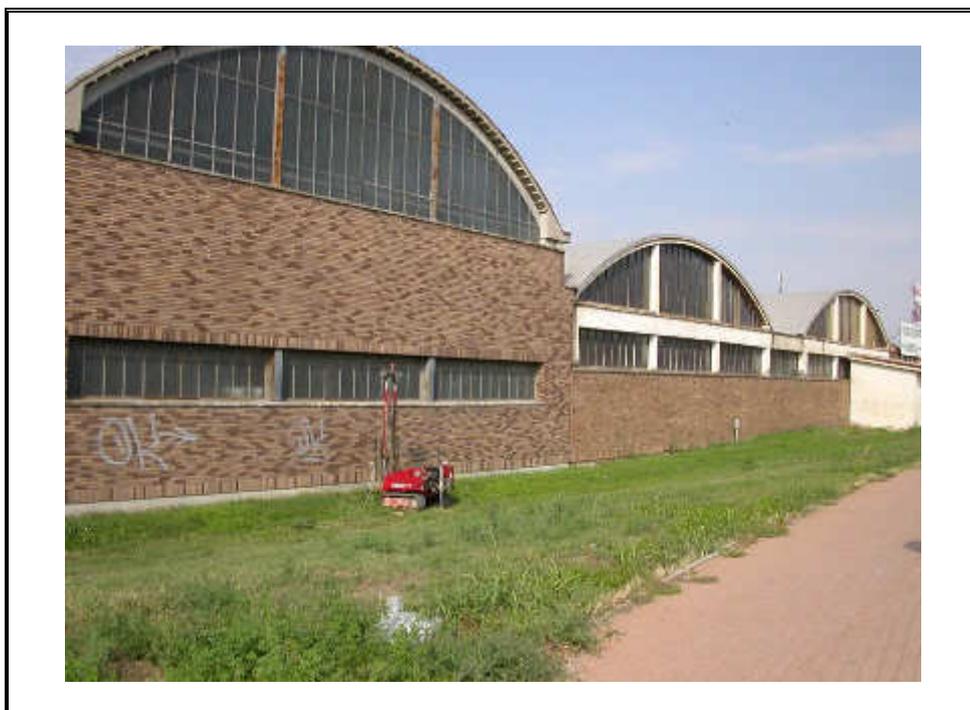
Posizionamento prova penetrometrica dinamica P6.
